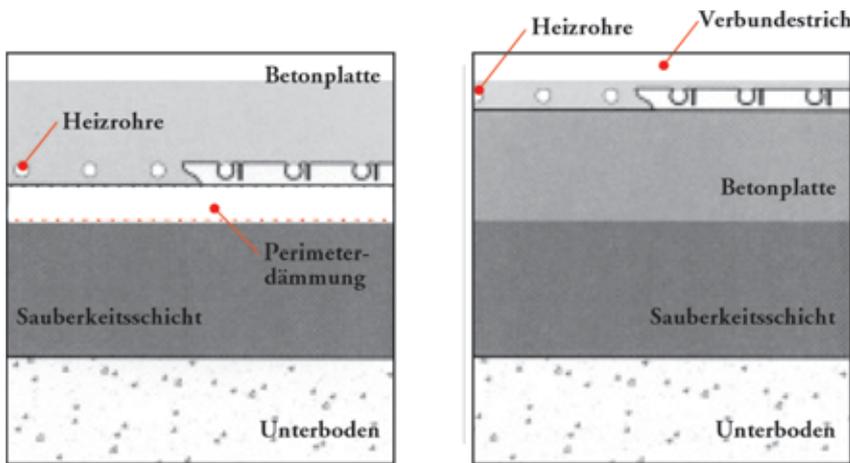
Industrieflächenheizung im Beton und Verbundestrich
